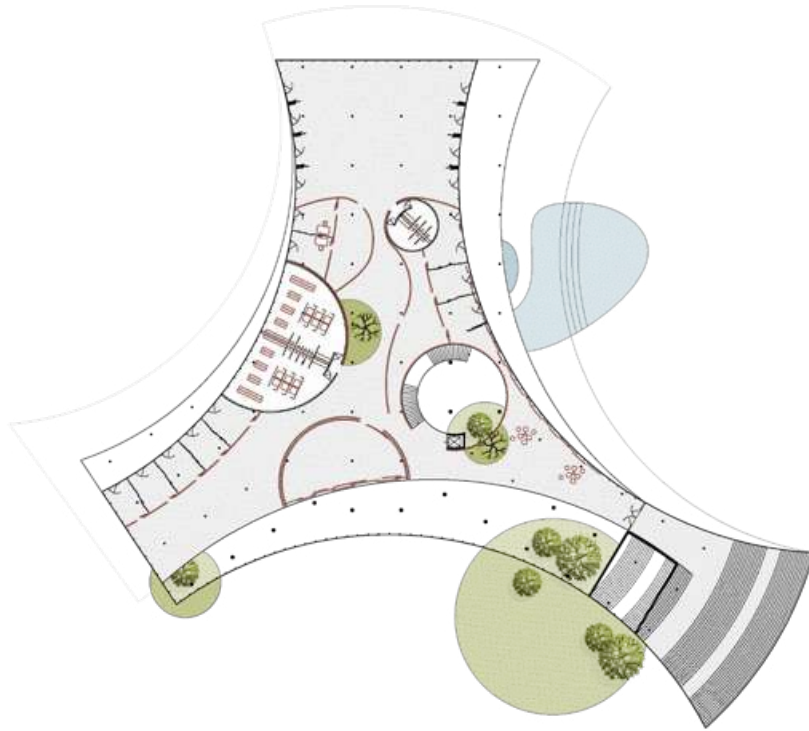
Flexibilität Grundriss Obergeschoss 01
